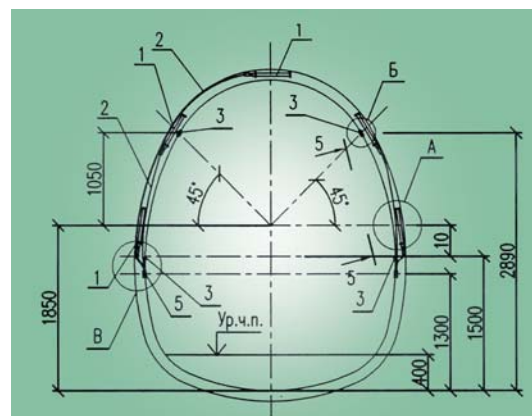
Постоянная обделка из набрызг-бетона эвакуационно-вентиляционной выработки: 1 – датчики напряжений, 2 – кабели
